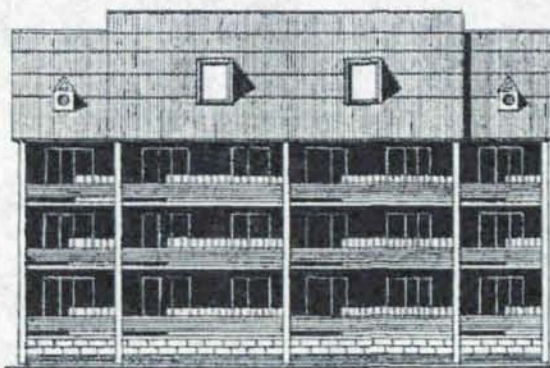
"Буферные зоны" в виде остекленных веранд на фасаде здания
